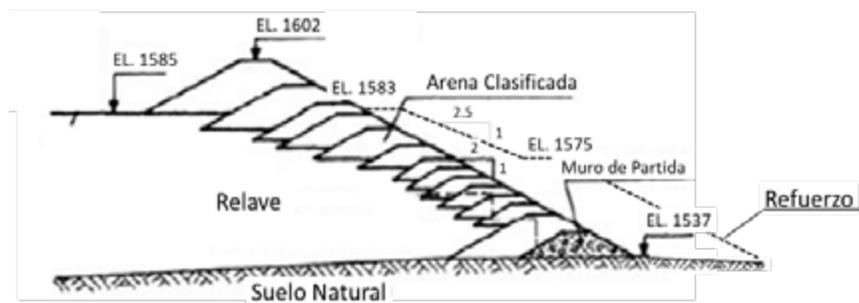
Sección muro 1 del Depósito Barahona 1
